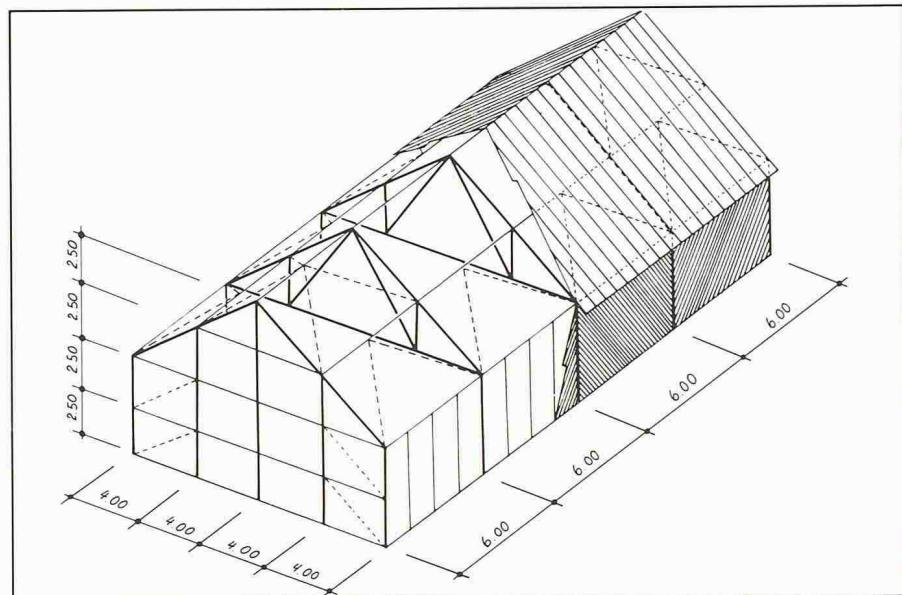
Testobjekt 1: Grunddaten einer Holzkonstruktion
